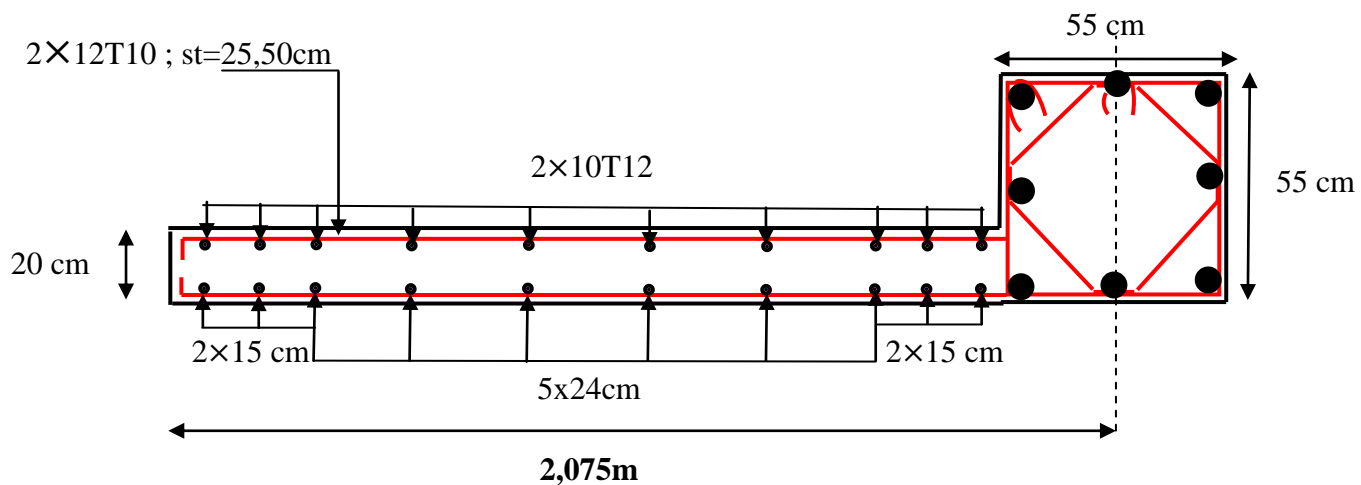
Schéma de ferrailage du voile (Sens y-y ;L= 2,075m) pour RDC
